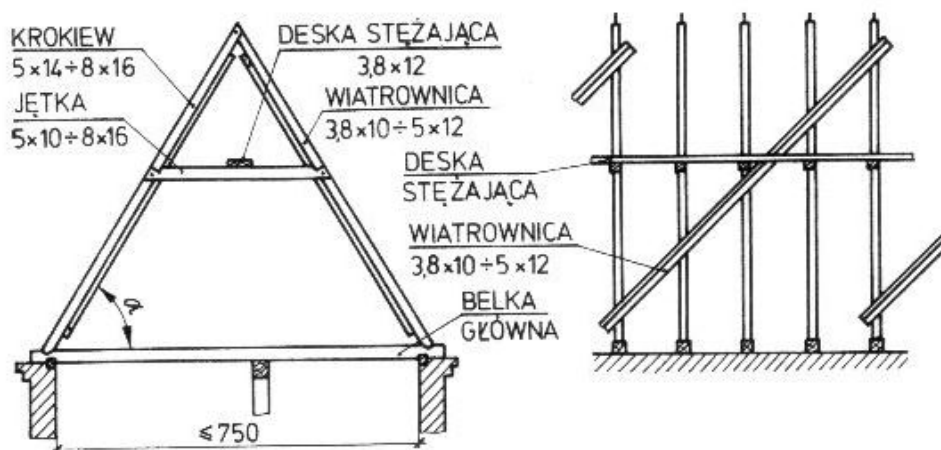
Dach o konstrukcji krokwiowej [8, s. 101]
